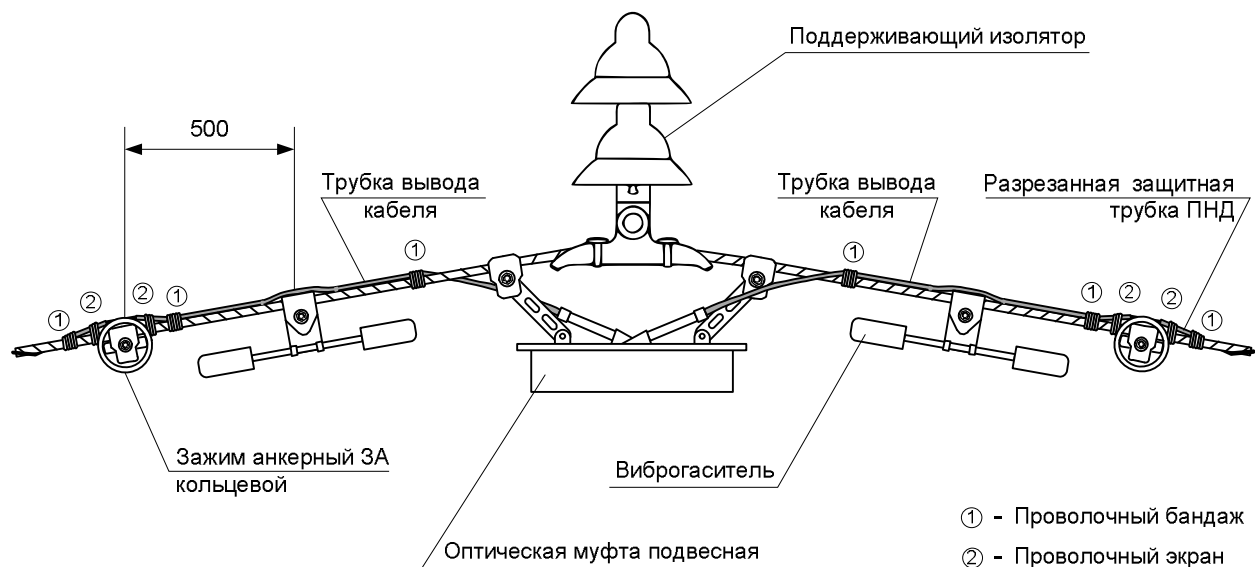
Подвесная муфта для соединения строительных длин ОКНН
